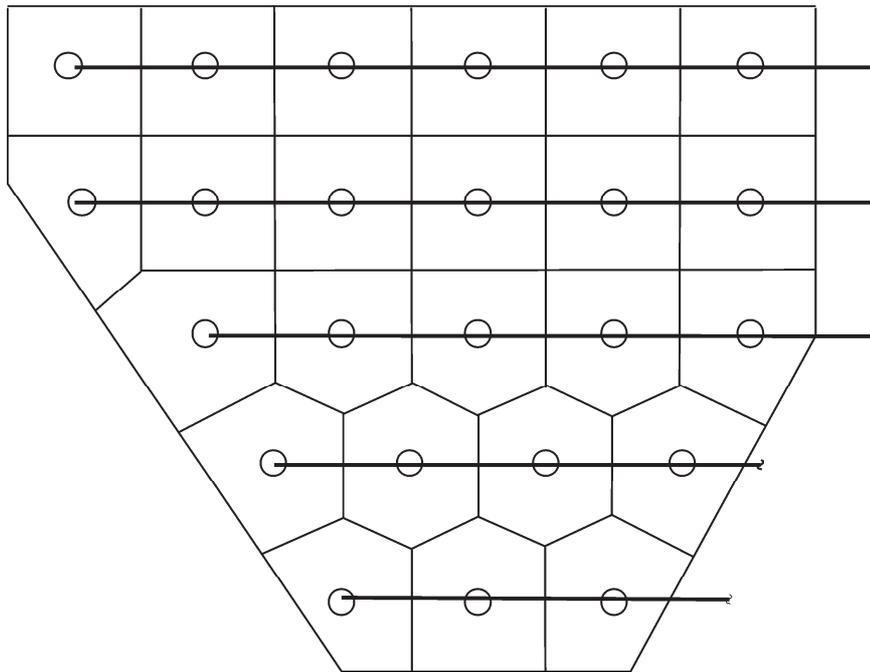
Bestimmung der Schutzfläche je Sprinkler
